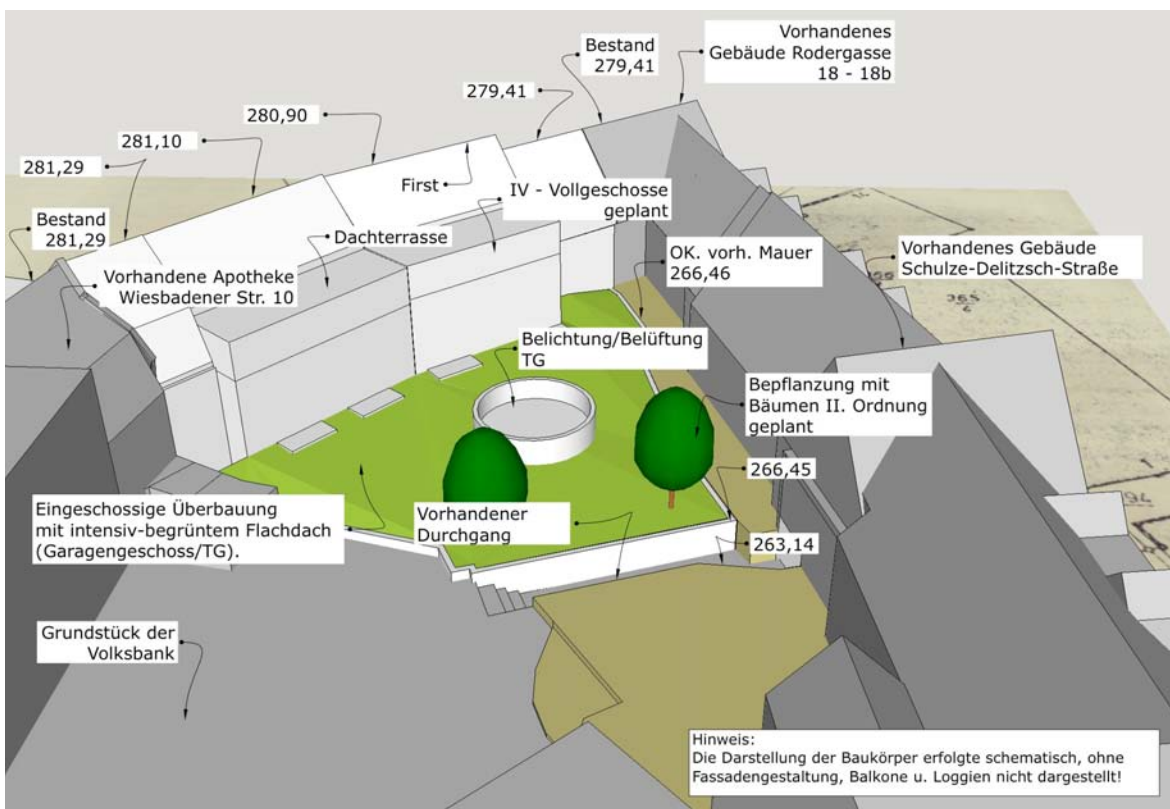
„Geplante Bebauung, Grundlage der 4. Teiländerung des Bebauungsplans "Löherplatz" Stand Dez. 2016“
